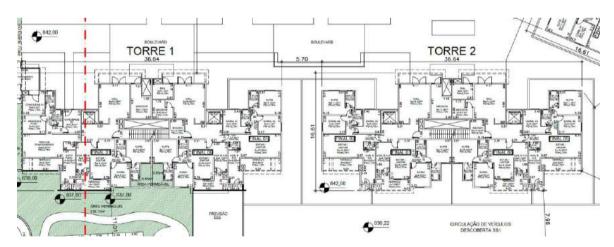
Projeto - Pavimento Térreo - Torres 1 e 2.
